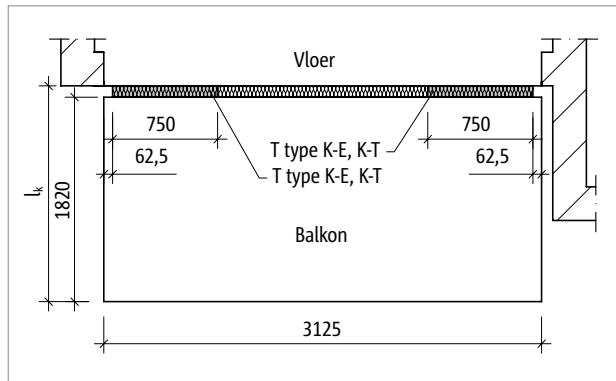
Schöck Isokorf® T type K-E: Aansluiting van prefabbalkons met plaatdikten van 160 mm tot 200 mm met IDock2
